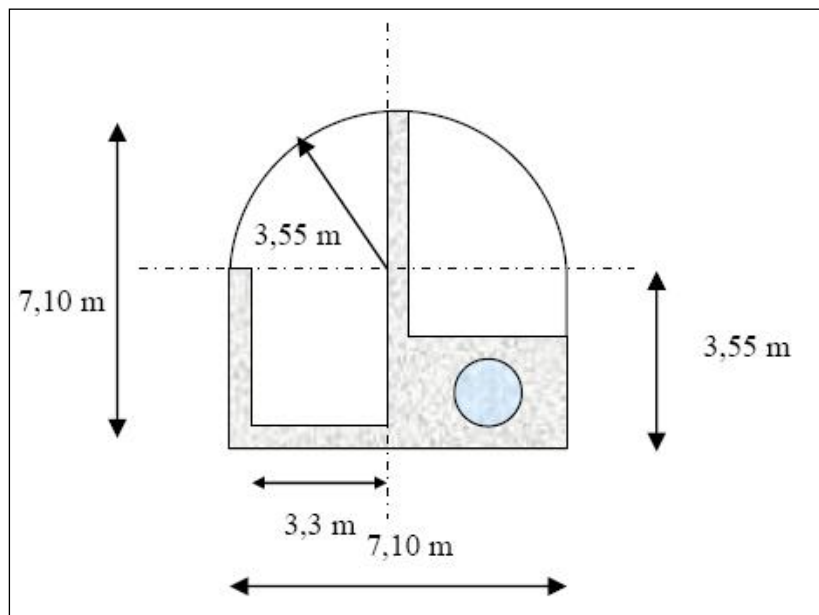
Sección tipo, tramo aguas abajo de la Caverna de Válvulas. Fuente: proyecto construcción Embalse de Chacrillas.
